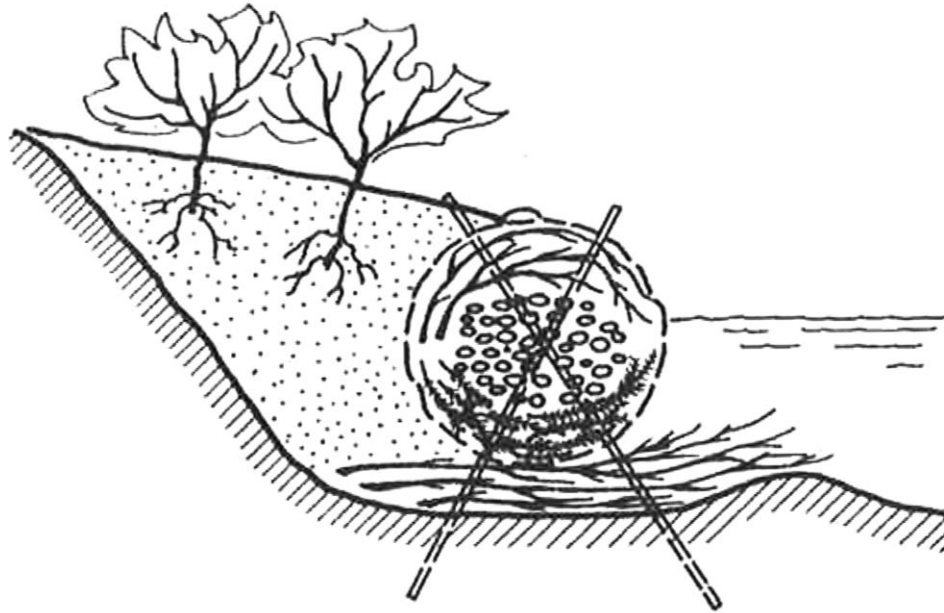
Hinterfüllung, Bepflanzung (Bauvorgang 5, Faschinenwalze)
